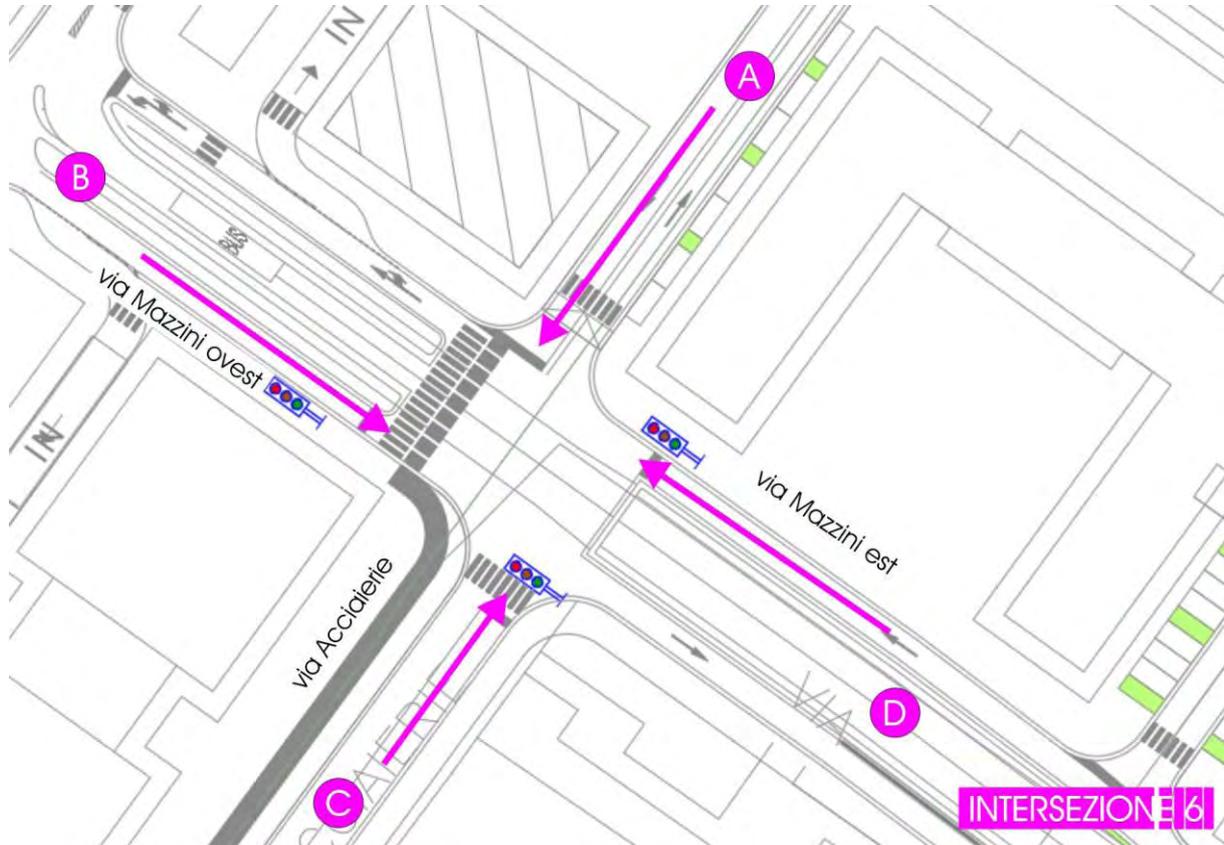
Scenario di Intervento 0 – Planimetria intersezione 6
